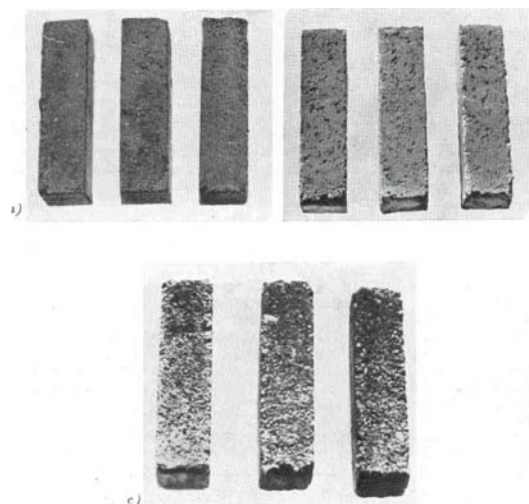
Especímenes de concreto con cemento resistente a los sulfatos, clinker 58%, escoria de alto horno 36% y yeso 6%, en soluciones de SO_3 que contenían: a) 2170, b) 12290, c) 30700 mg/lit. Fuente: Biczók, I. Concrete Corrosion, Concrete Protection. Cap. I.
